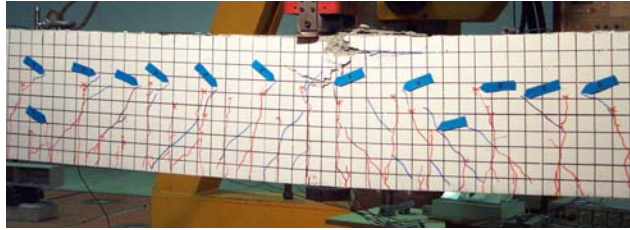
Poutre en flexion trois points. Profil de fissuration expérimental
